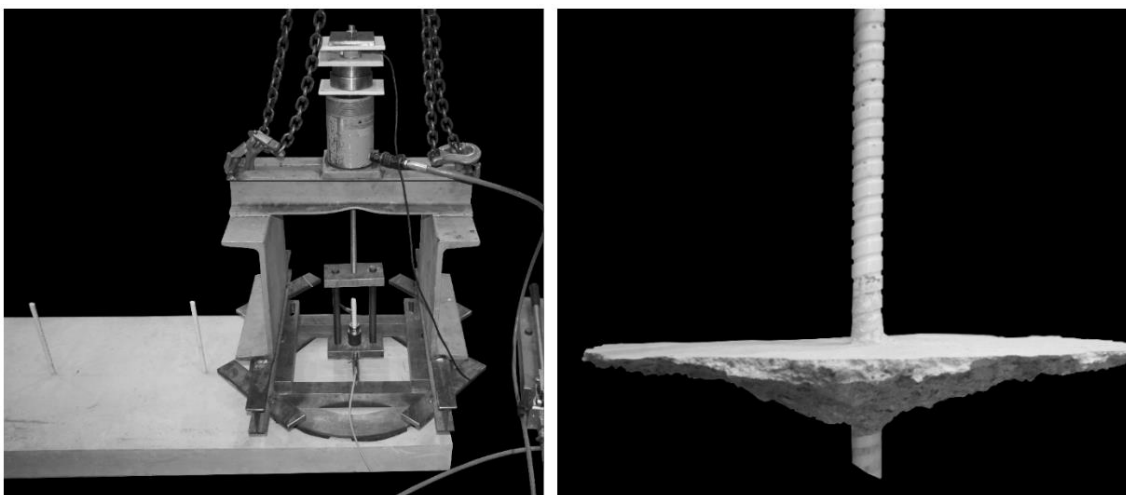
Auszugversuche am Isolink-Verbindungsmittel - Versuchsaufbau (links); typisches Versagensbild Betonausbruch (rechts).
